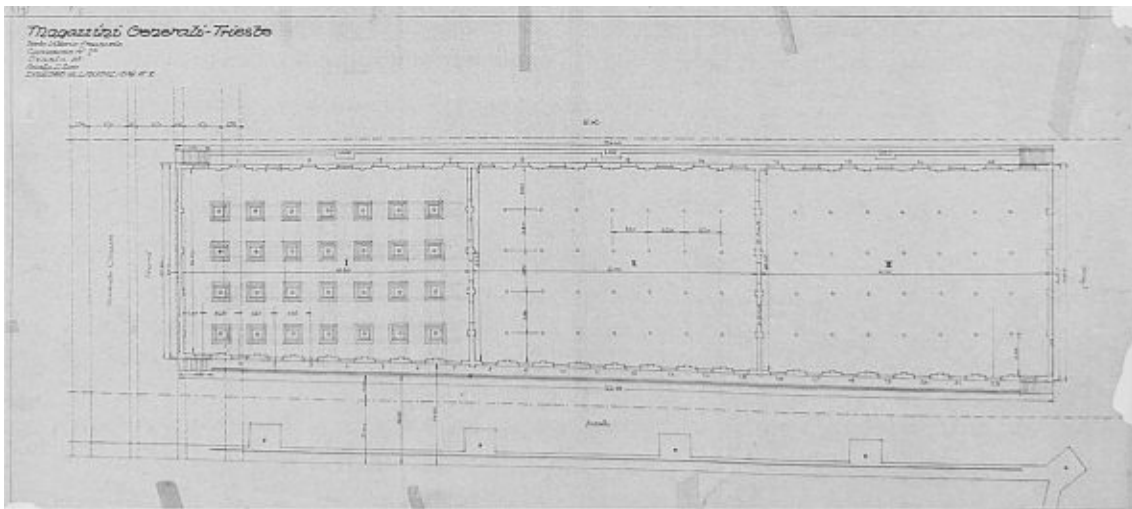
Lagerhaus 1a, Grundriss
